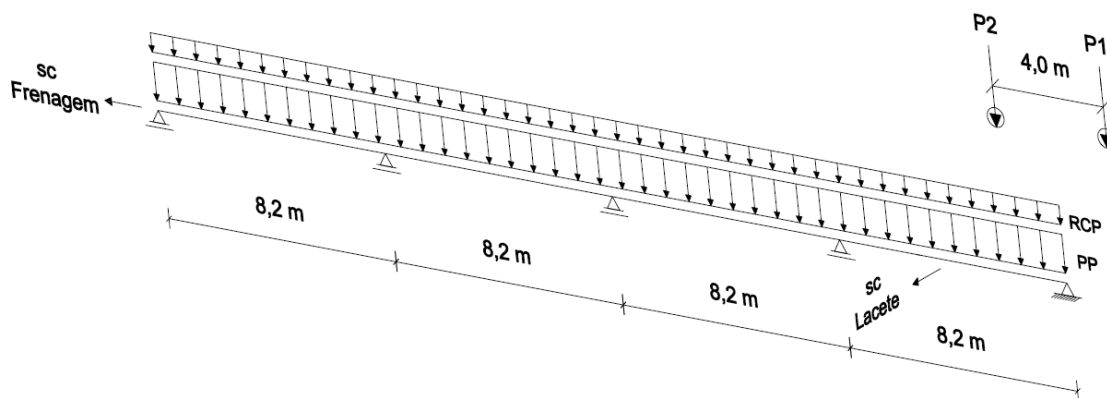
Modelo estrutural e ações consideradas no pré-dimensionamento das vigas da ponte rolante.
